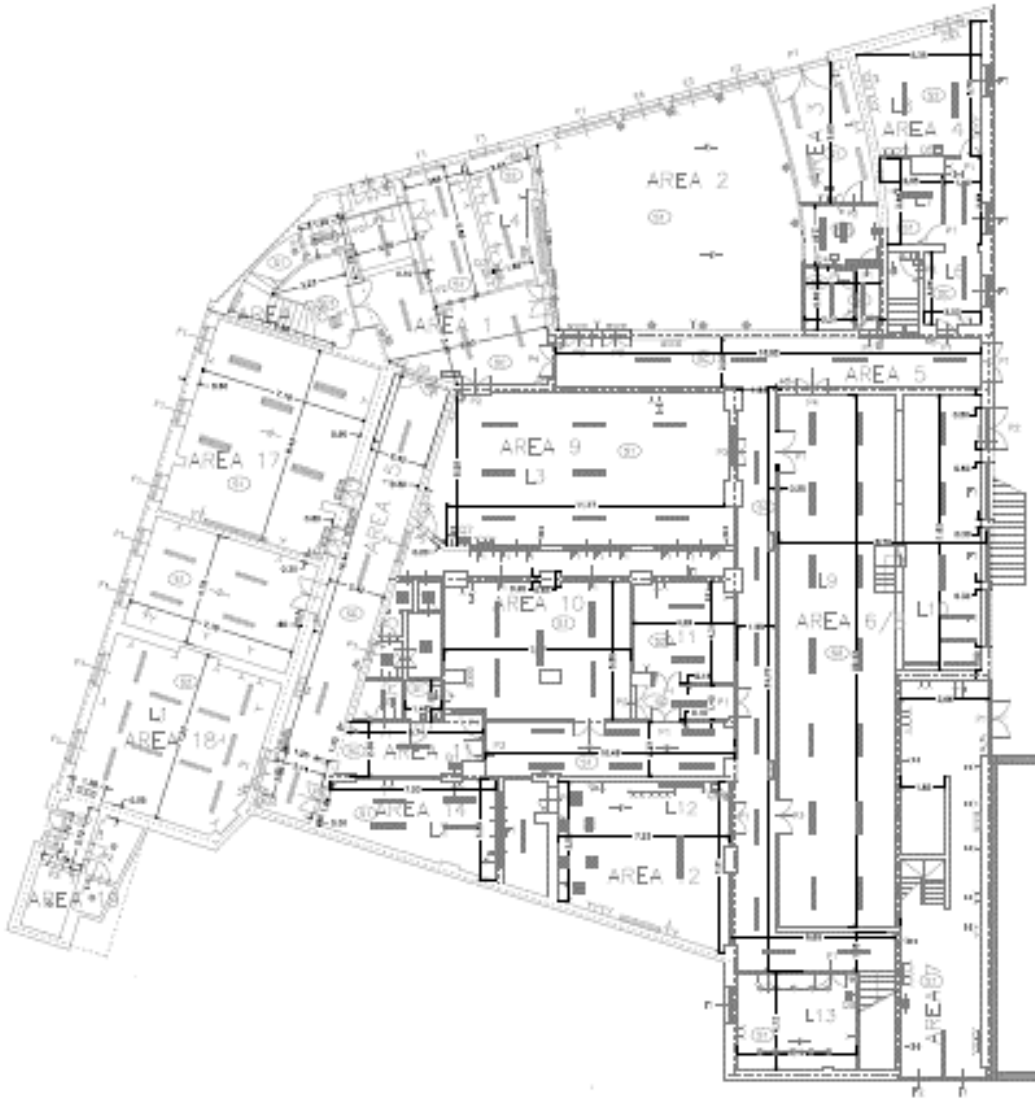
7: Rilevamento dello stato attuale in pianta. Piano Terra
